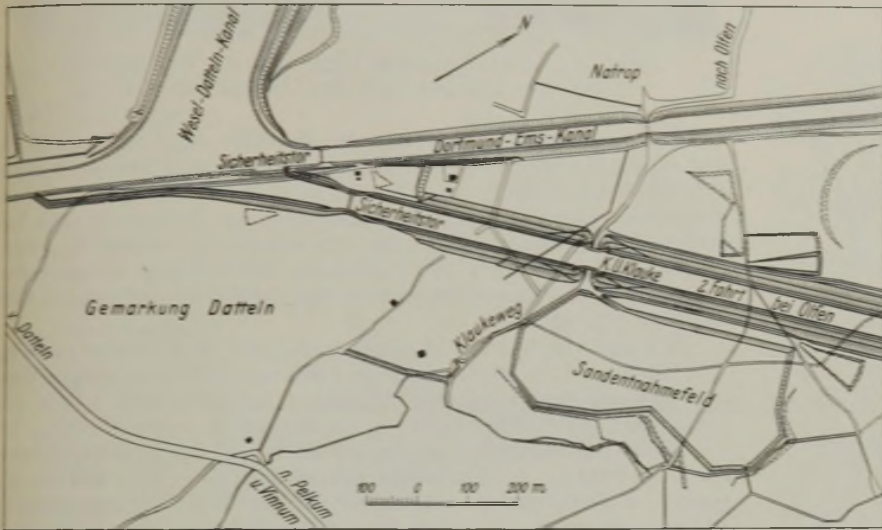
Lageplan der Kanalüberführung Klauke mit Verlegung des Klaukeweges.
